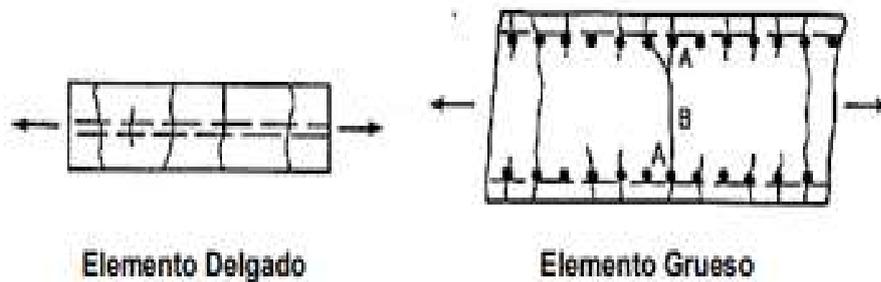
Grietas en elementos de concreto por tracción diagonal del concreto. [52]
